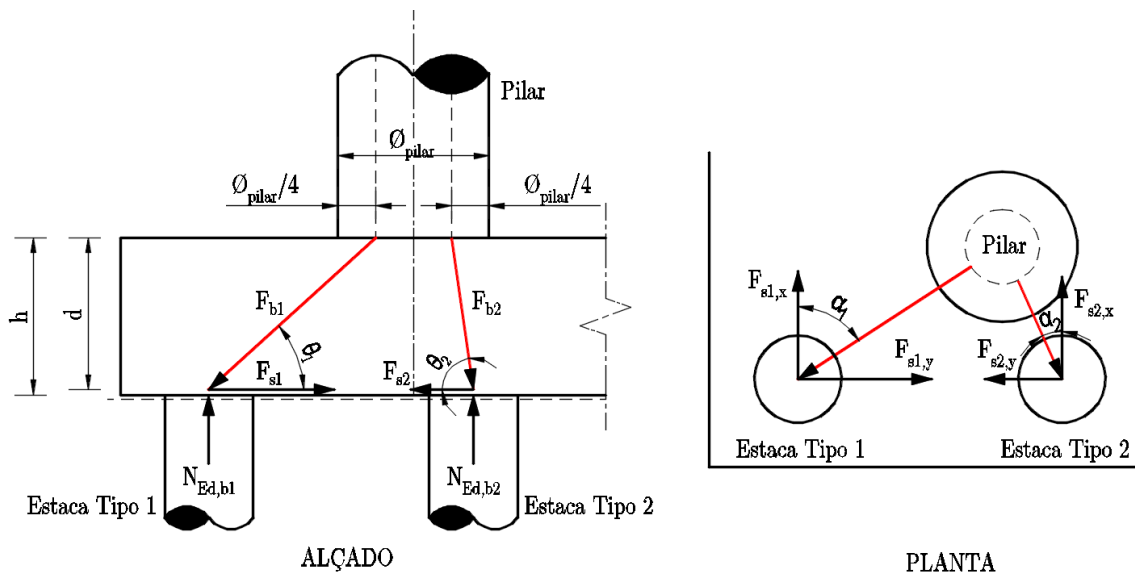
Alçado e planta esquemáticos das bielas na zona do maciço de encabeçamento
